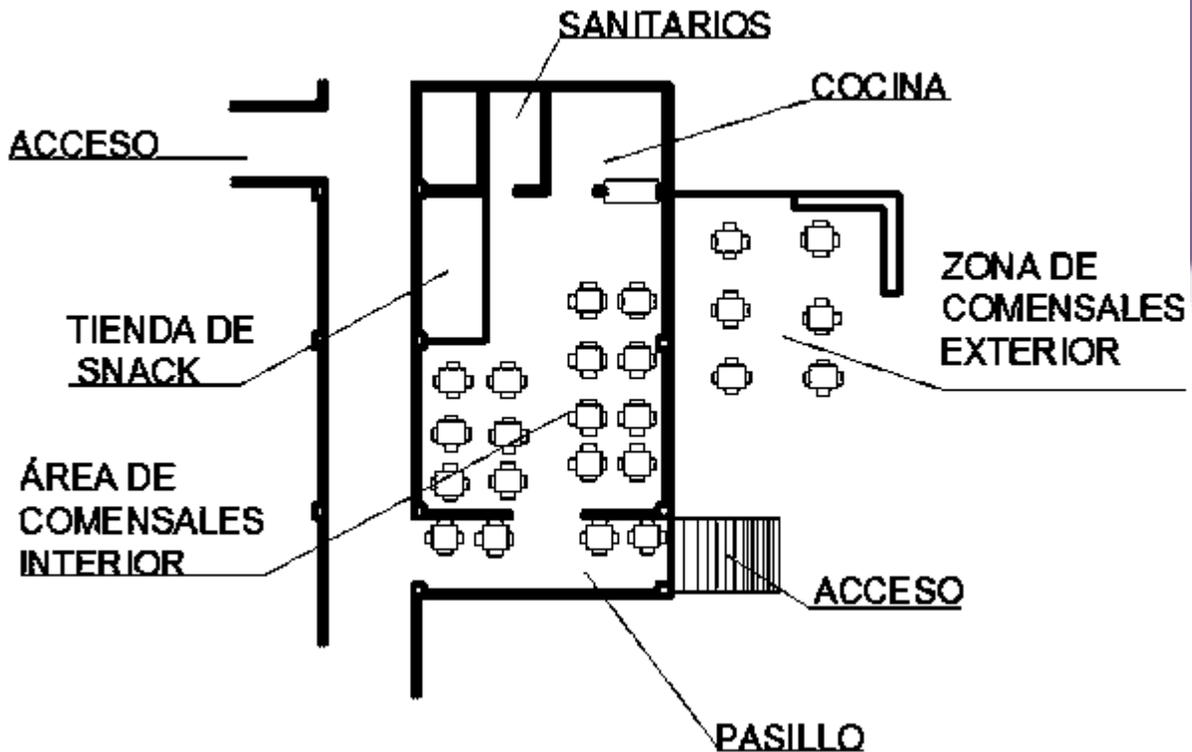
Vista de la planta de la cafetería del edificio de Posgrado de la UNAM. Editada por RGV,
